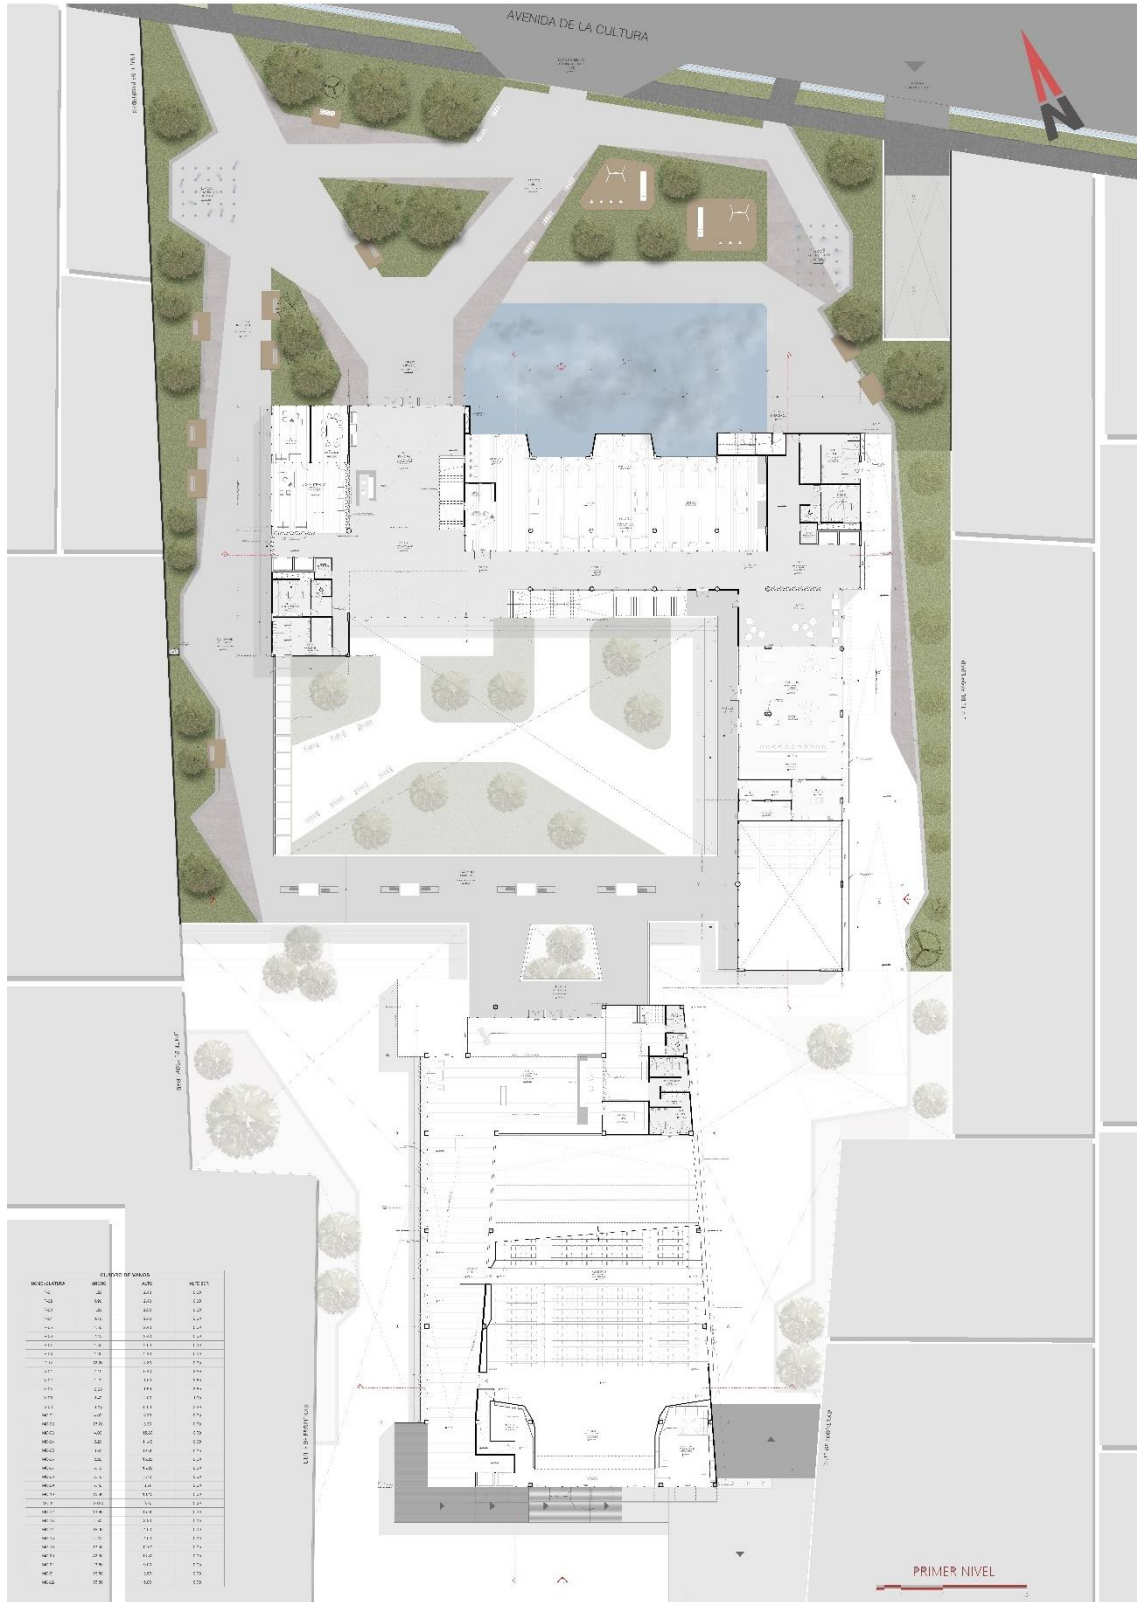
Zonificacion de espacios – Planta Primer nivel
